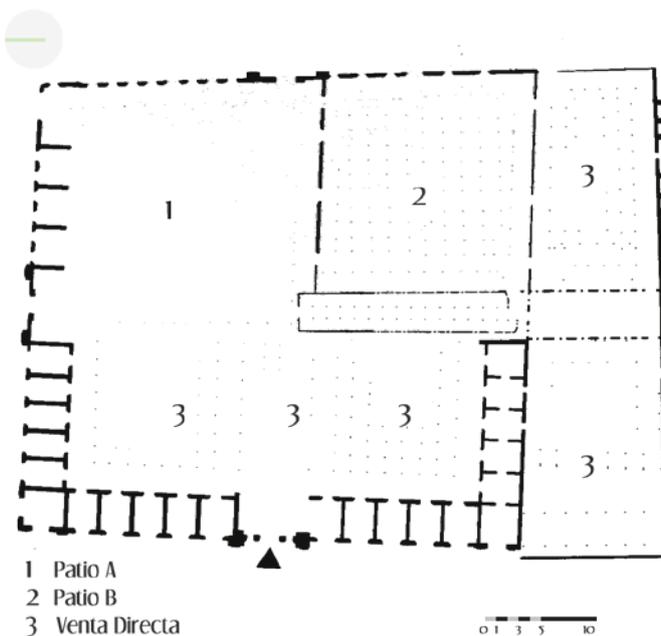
PLANTA ARQUITECTÓNICA MERCADO MUNICIPAL
